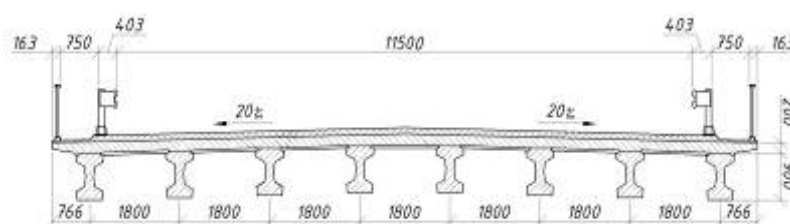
Поперечний переріз прогонової будови з застосуванням профільного настилу в якості незнімної опалубки
